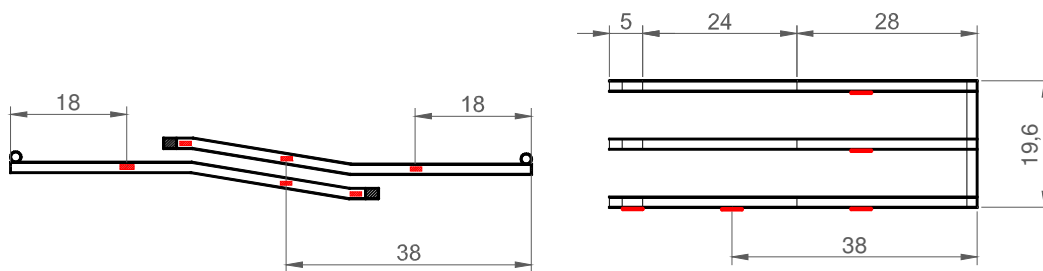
Detalhe da armadura do consolo e posicionamento dos extensômetros (medidas em cm)
